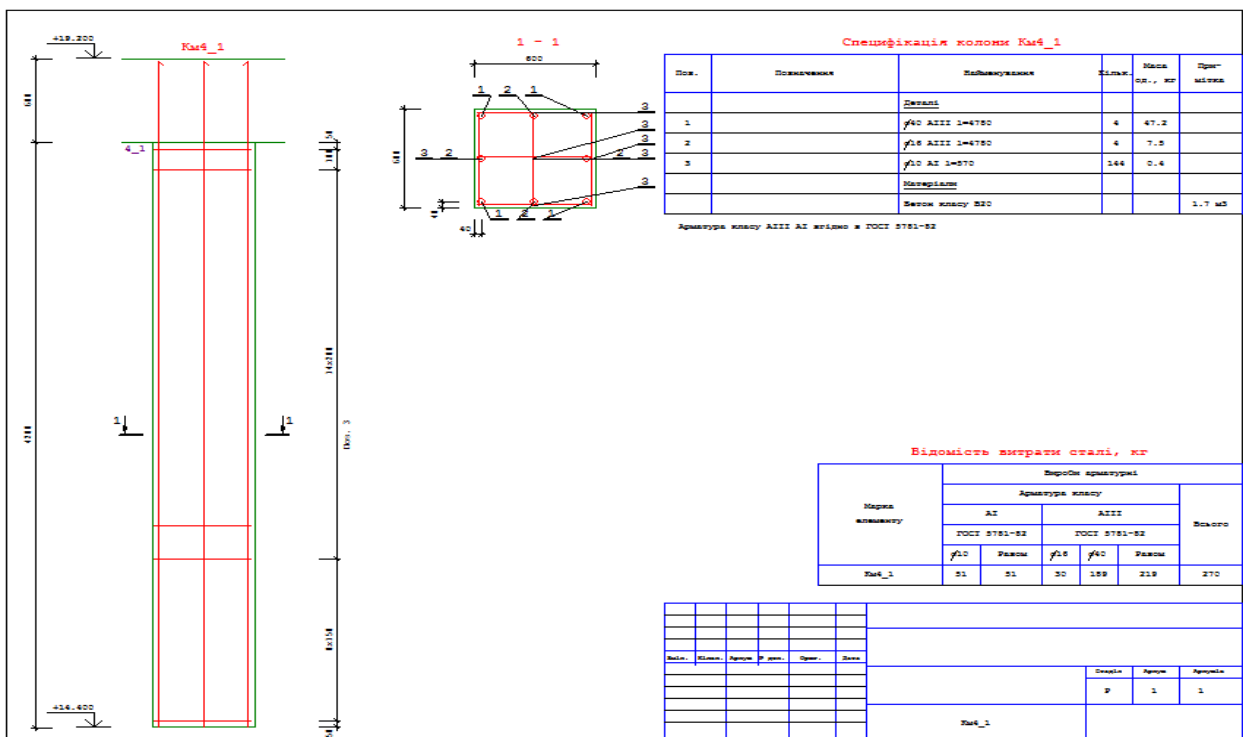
Варіант будівлі з балочно - плитним перекриттям. Колонна К4-1. Креслення робочого проекту.
